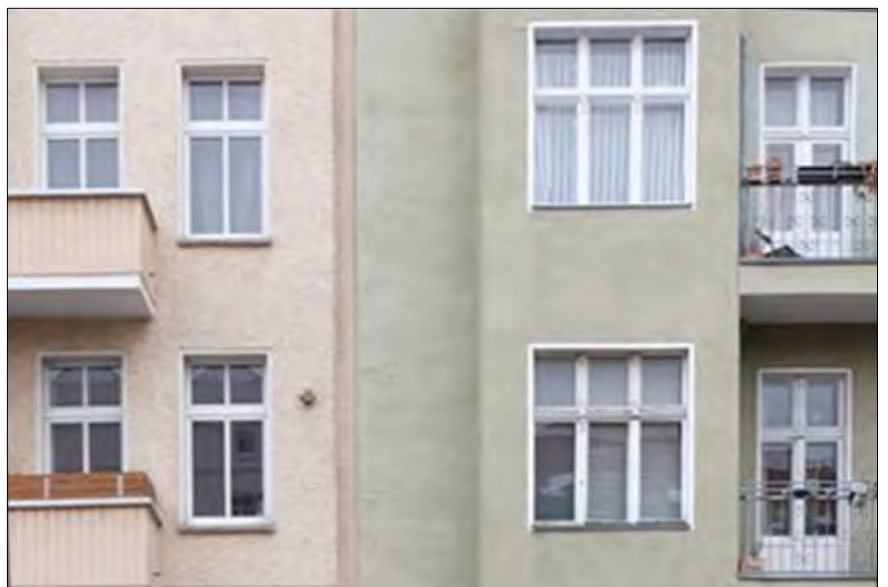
Kunststoffenster mit Isolierverglasung (links) und baualterstypische stadtbildprägende Holzkasten-Doppelfenster (rechts) in der Baumschulenstraße (Foto: Planergemeinschaft)
